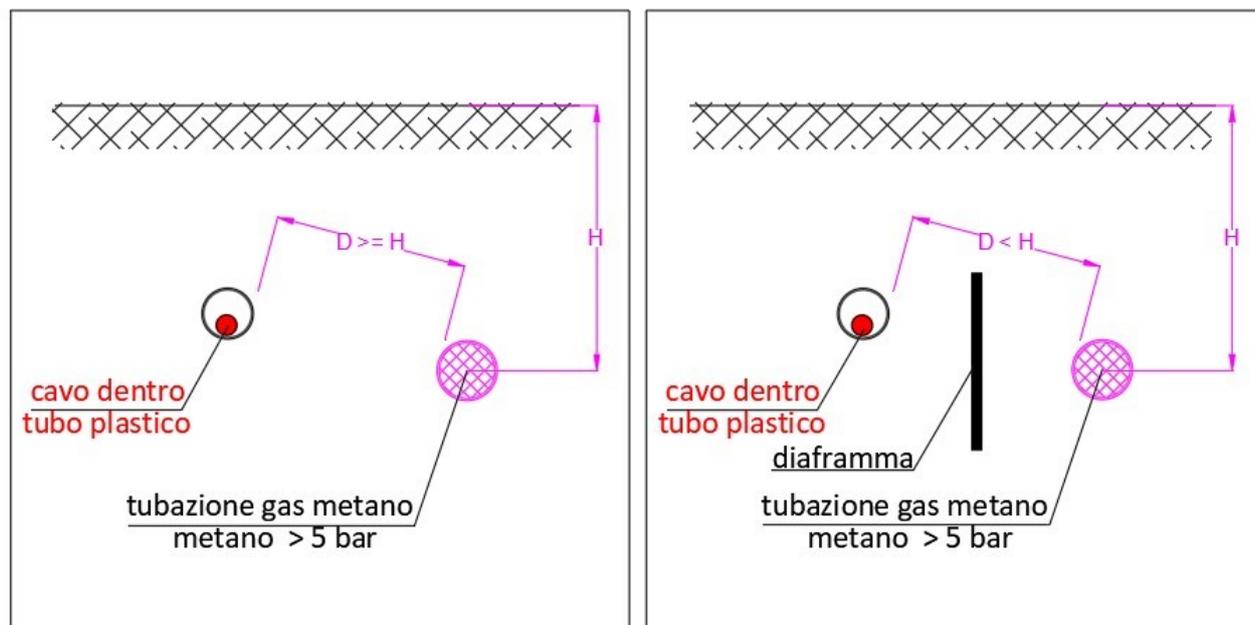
Parallelismi cavidotto energia e tubazioni o serbatoi con pressione > 5 bar
